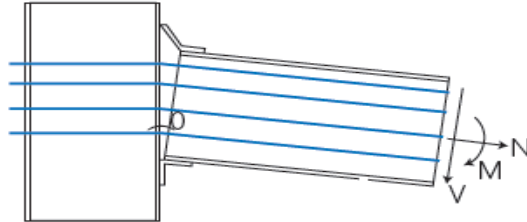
c Conexión postensada viga-columna (configuración deformada).
